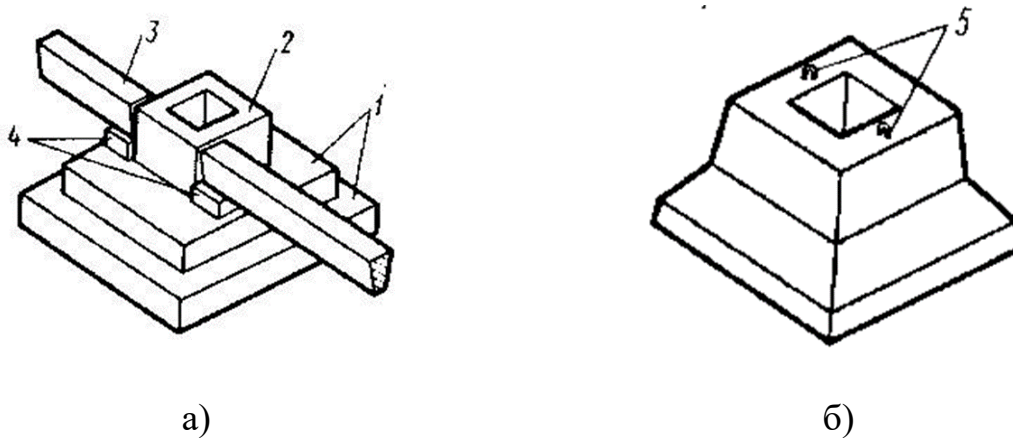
Збірний фундамент під колону: а – з декількох елементів; б – з одного елемента; 1 – фундаментні плити; 2 – підколонник; 3 – рандбалка; 4 – бетонні стовпчики; 5 – монтажні петлі
